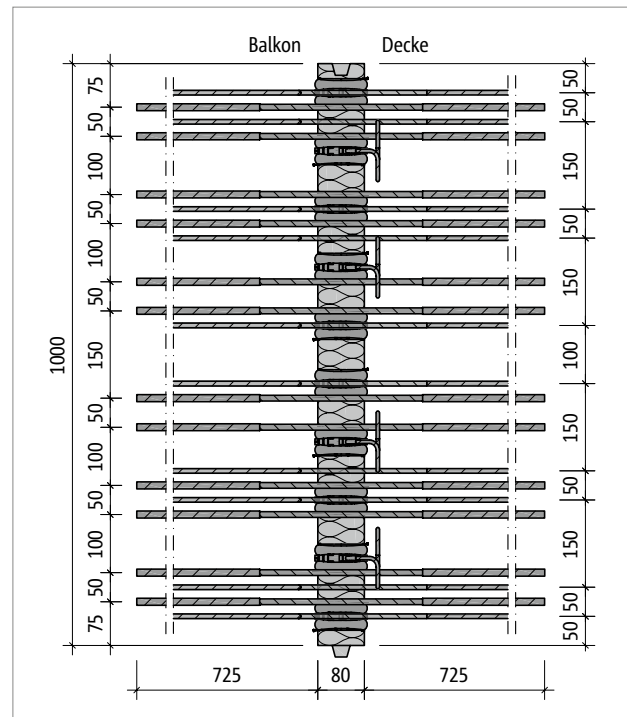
Schöck Isokorb® T Typ KL-M10-V2: Produktgrundriss
